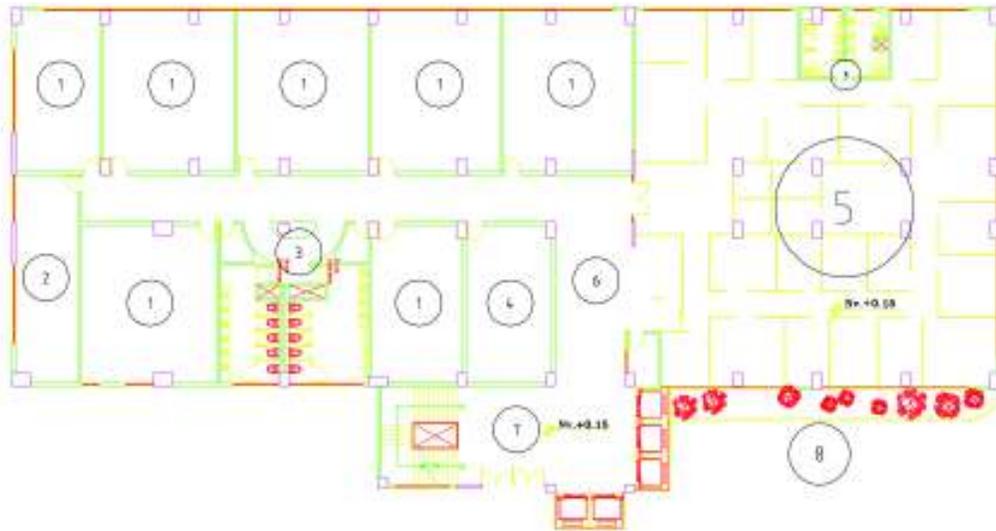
Distribución EARME primera etapa, Planta baja
